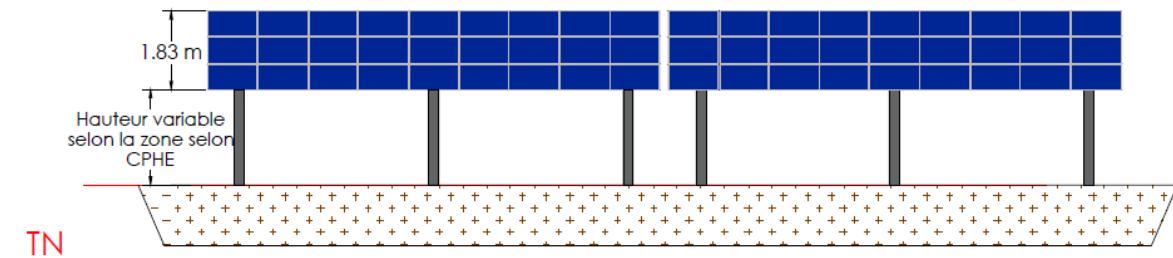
Coupe des tables photovoltaïques 3V27 au sol - Vue de face (source : ÉLÉMENTS)
